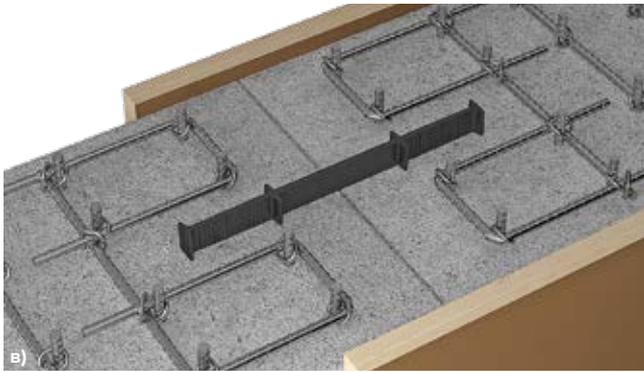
в,г. Этапы работ по установке гидрошпонок серии TH Фундамент ДШВ
